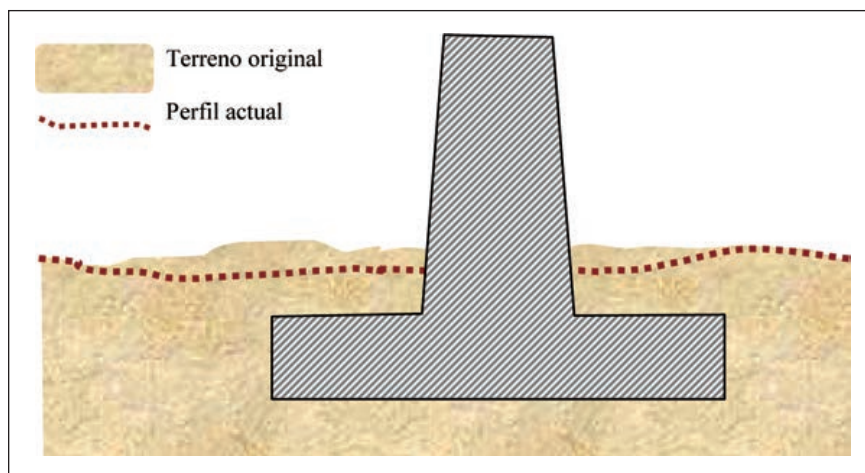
SOCAVACIÓN MODERADA EN PILA.
